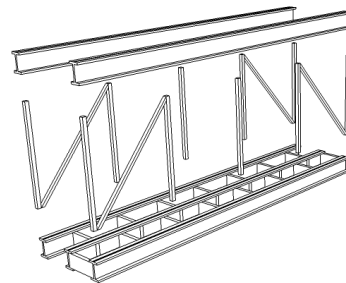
Esquema explotado de estructura de puentes basados en las mismas vigas doble T usadas en los edificios.
